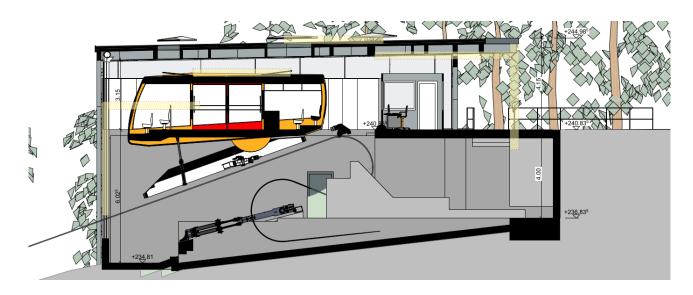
Schnitt geplante Bergstation mit ebenerdigem Ein-/Ausstieg (Quelle: Garaventa)
